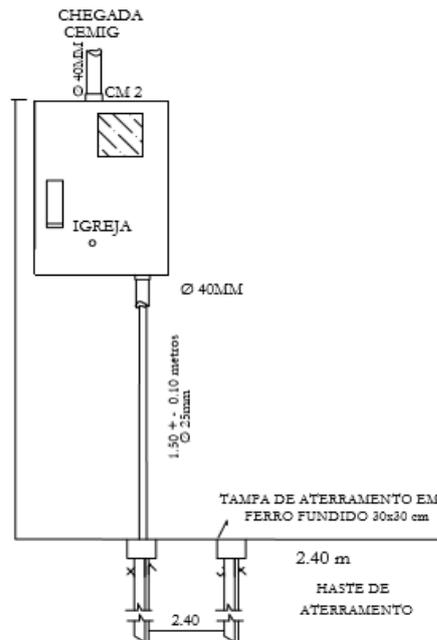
Detalhamento da planta de localização do padrão Cemig
